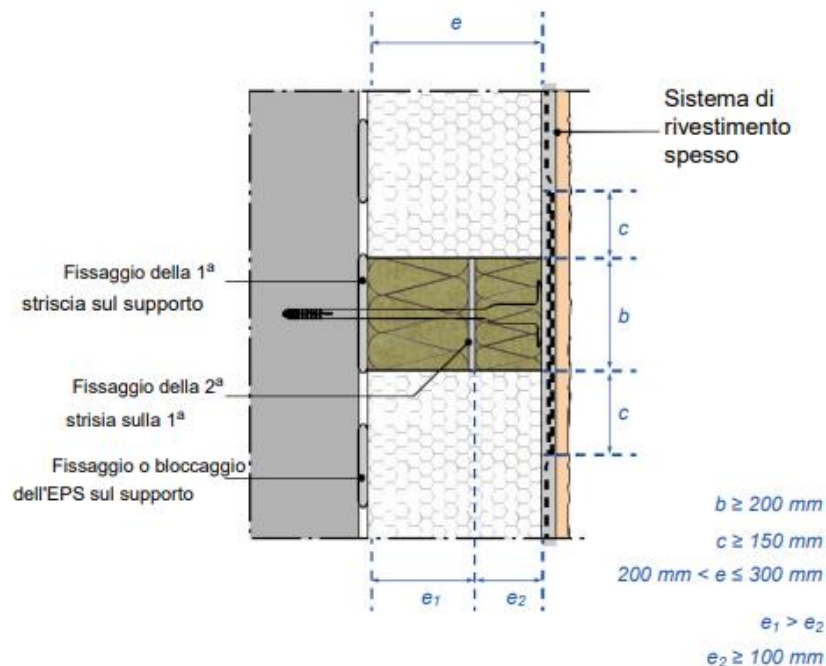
Soluzione A - Sezione con finitura esterna
